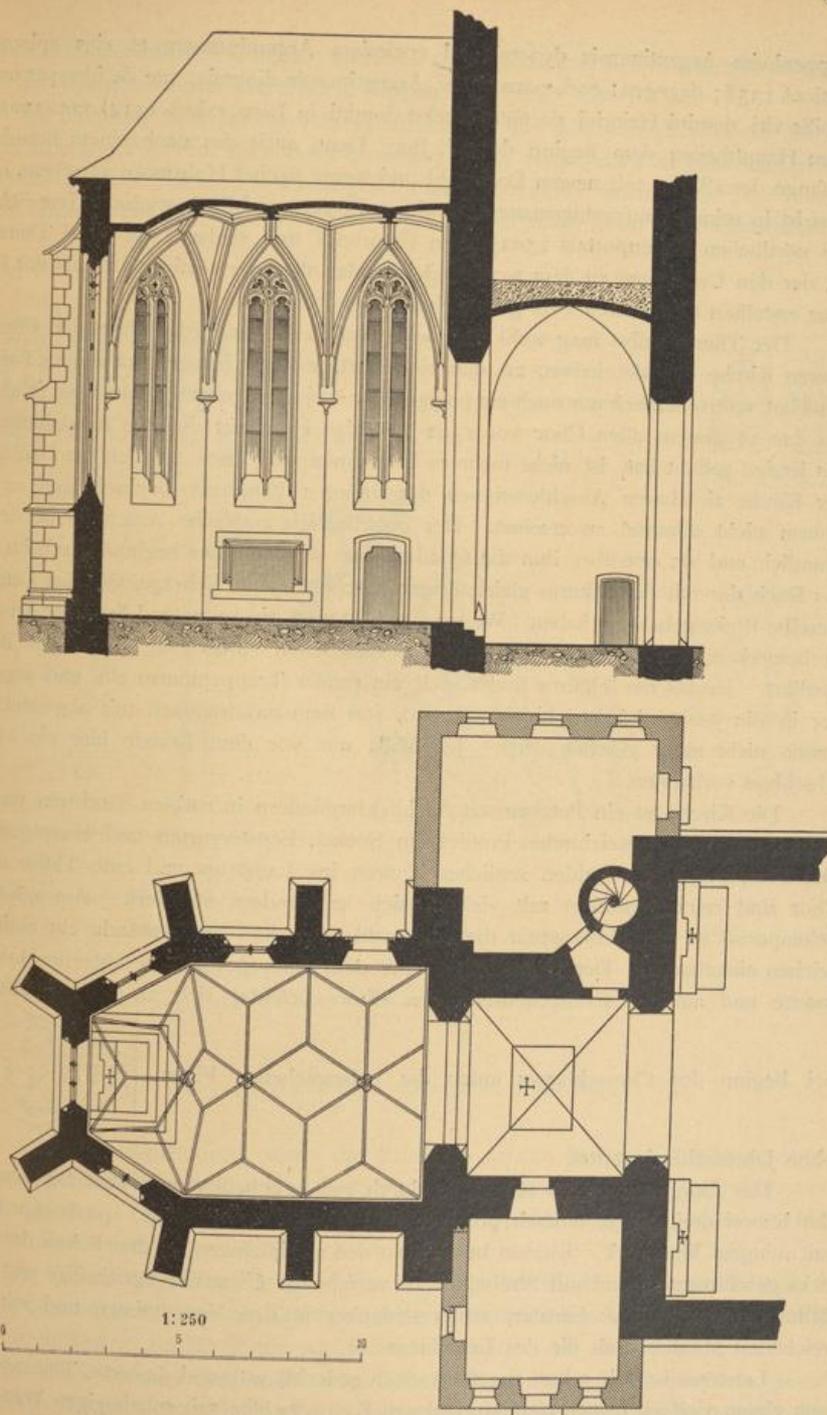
Kippenheim. Pfarrkirche. Grundriss und Längsschnitt durch Chor und Thurm.
